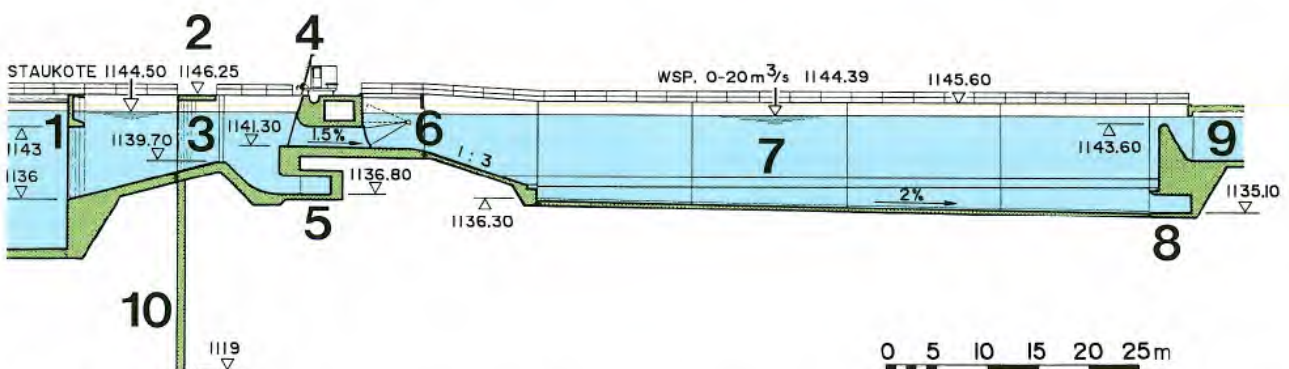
Fassung und Entsander Pradella, Längsschnitt. 1 Tauchwand, 2 Brücke, 3 Dammbalken, 4 Rechen, 5 Kiesspülkanal, 6 Segmentschütze, 7 Entsanderanlage mit Spülkanal, 8 Sandspülkanal, 9 Zuleitungskanal zum Ausgleichsbecken, 10 Einphasendichtungswand.
